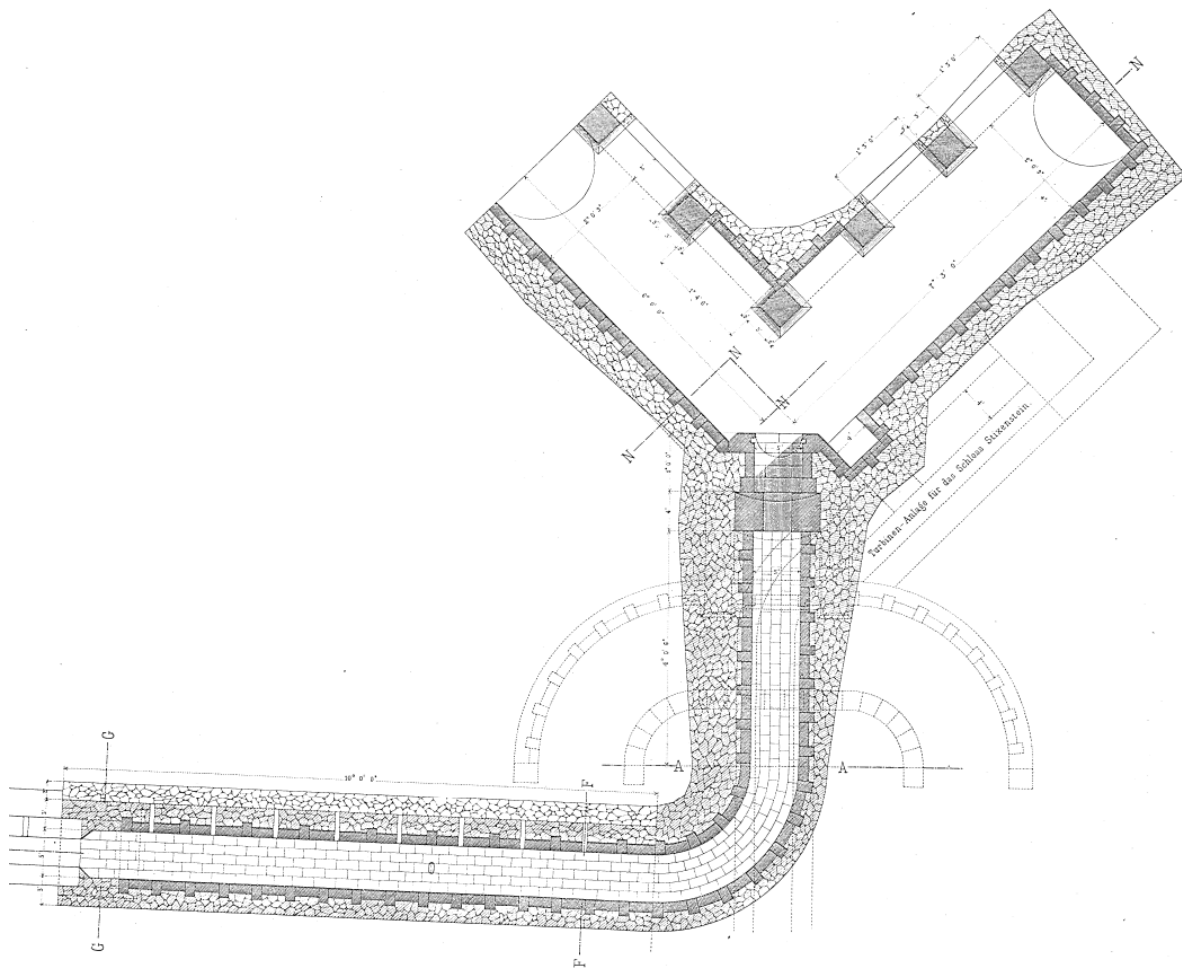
Grundriss Wasserschloss Stixenstein
